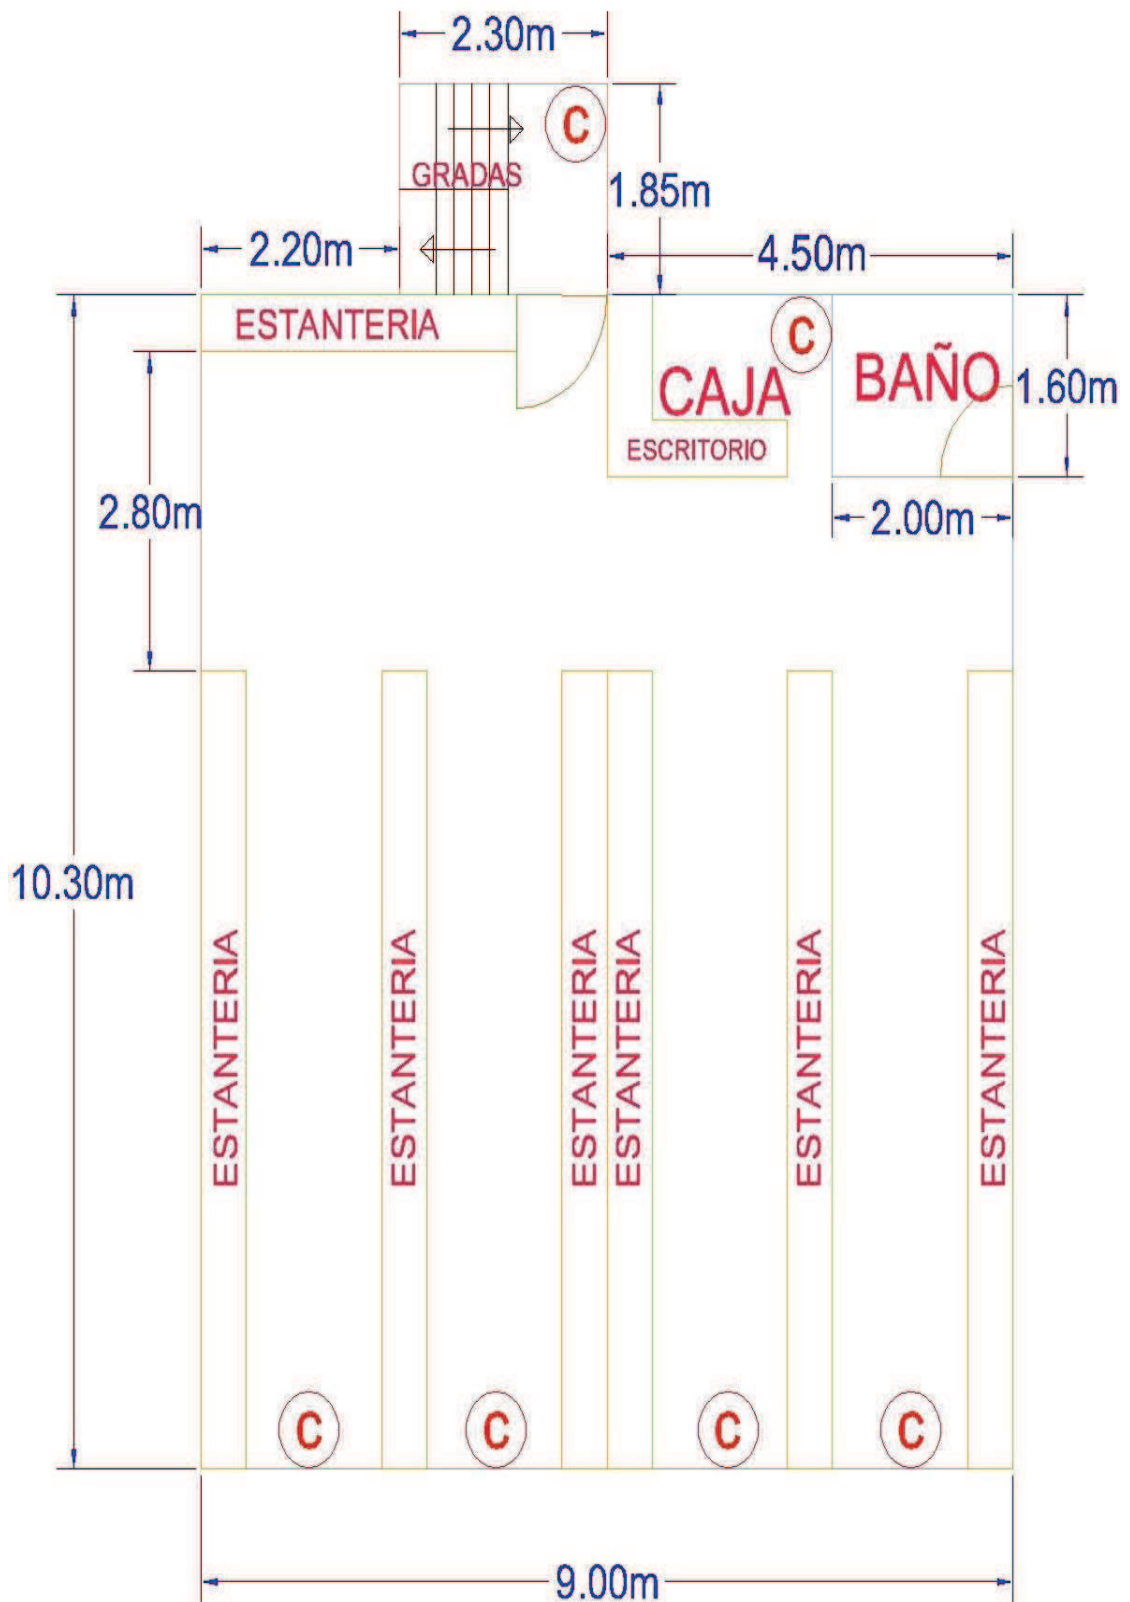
Localización de cámaras de seguridad en la primera planta del local
